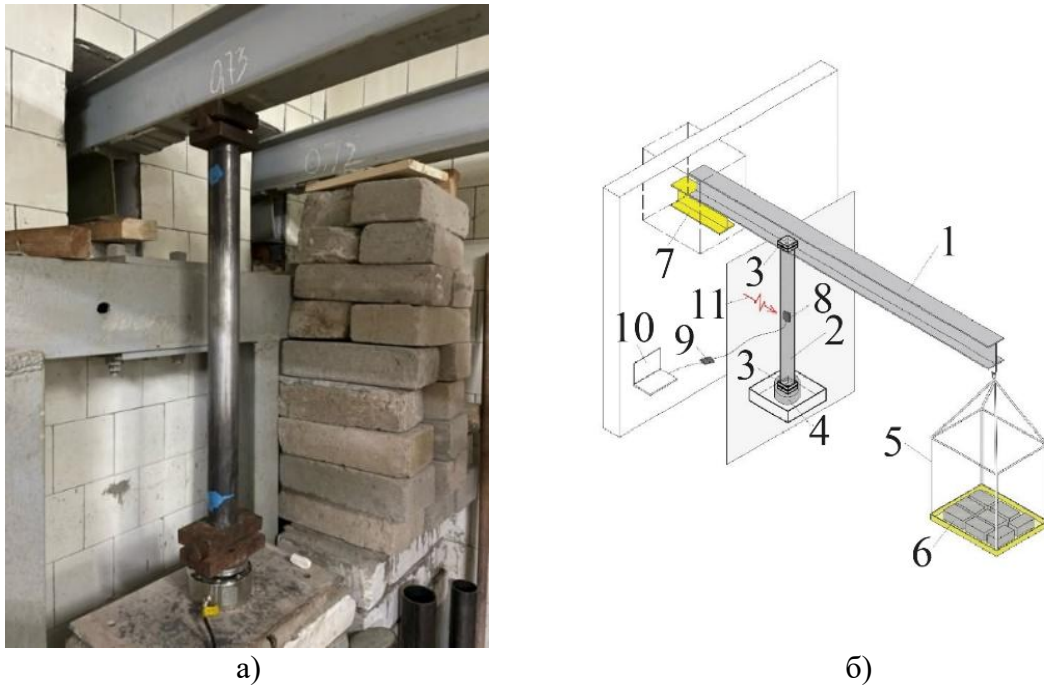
Испытания центрально сжатых образцов на определение собственных колебаний: а) общий вид; б) аксонометрическая схема экспериментальной установки: 1 – загружающий рычаг; 2 – испытуемый образец; 3 – цилиндрический опорный шарнир; 4 – силомер; 5 – корзина; 6 – гири; 7 – страховочная конструкция; 8 – блок акселерометра; 9 – модуль обработки сигнала акселерометра; 10 – ноутбук для регистрации осциллограмм и результатов измерений вибрации; 11 – импульсное воздействие с помощью ударника.
